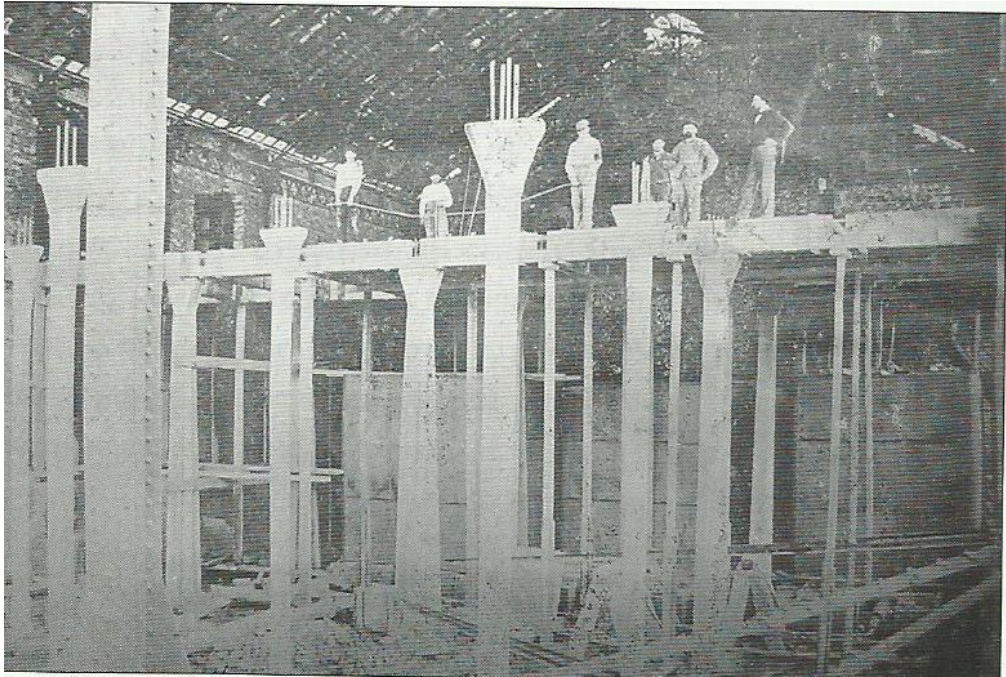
Construcción de los pilares y pisos del almacén de la azucarera de Lieres. Revista El Cemento Armado No.11 año 1901
